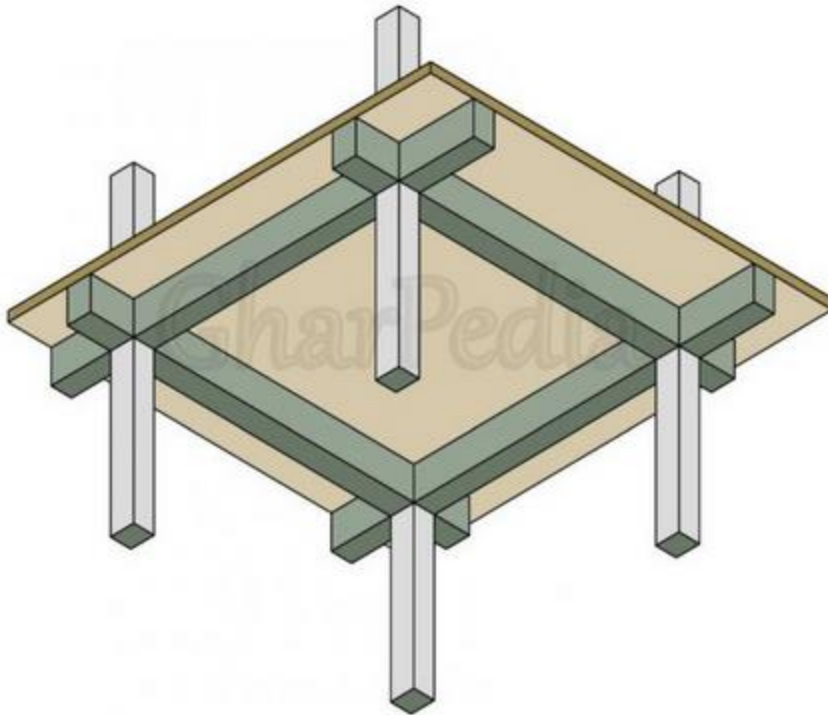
Монолітна залізобетонна плита спирається на балки (ребра) по контуру
